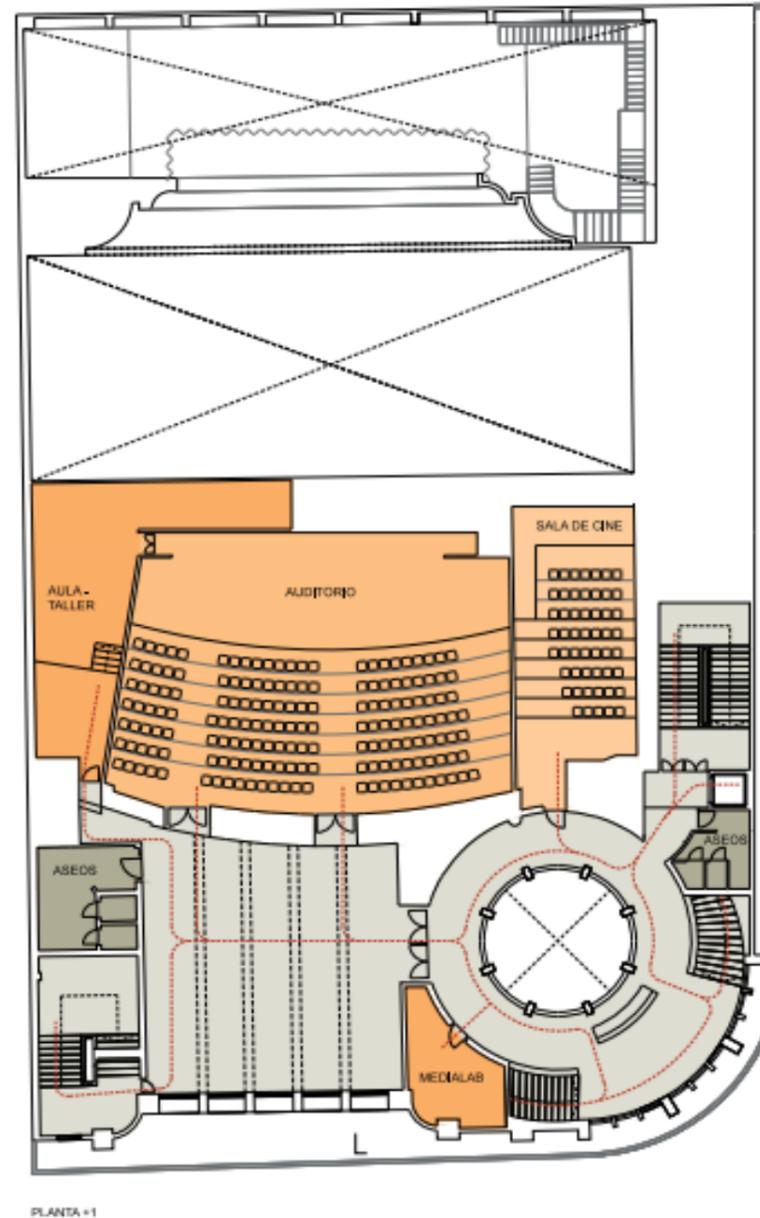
Planta arquitectónica Teatro LUX Segundo Nivel
